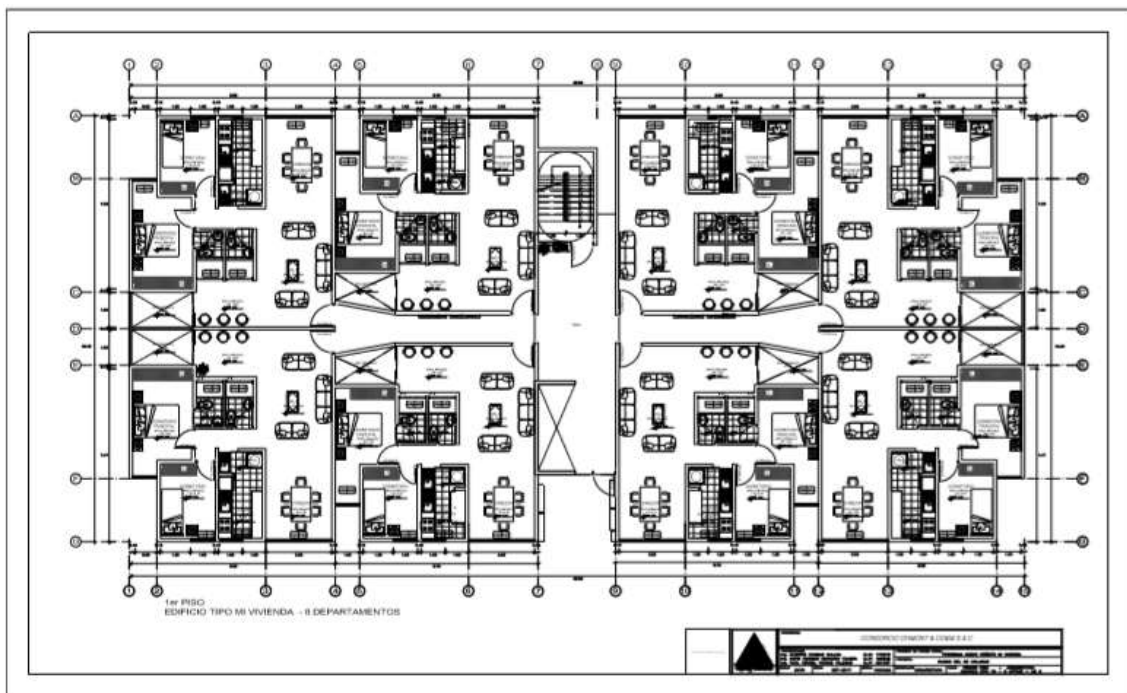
Plano arquitectónico de "Condominio Torres del Campo"
